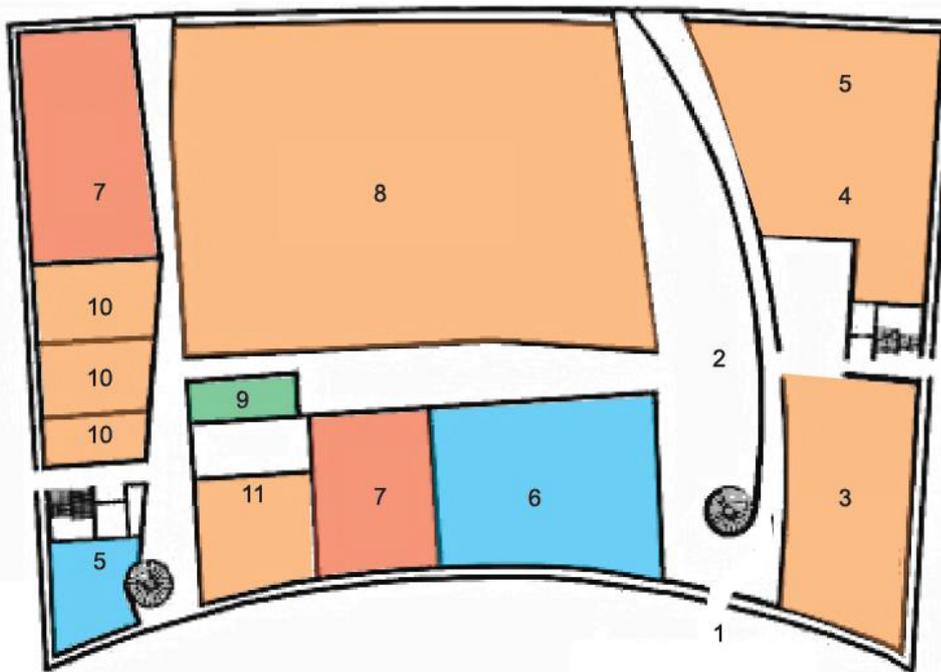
PLANTA PAVIMENTO TÉRREO – SEM ESCALA
